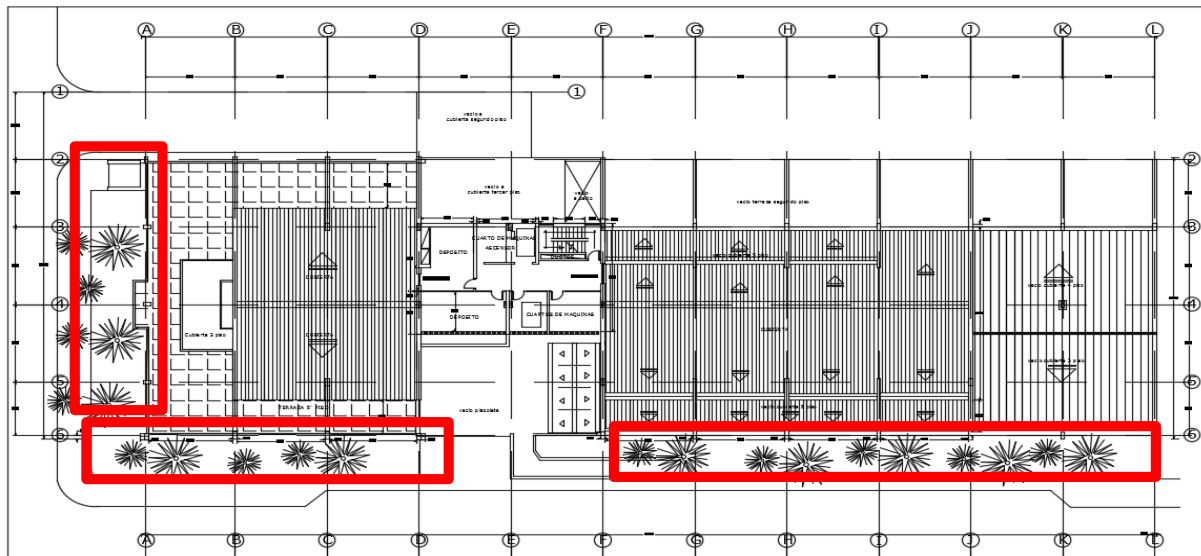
Planta general de jardineras perimetrales- zona exterior edificio calle 47
